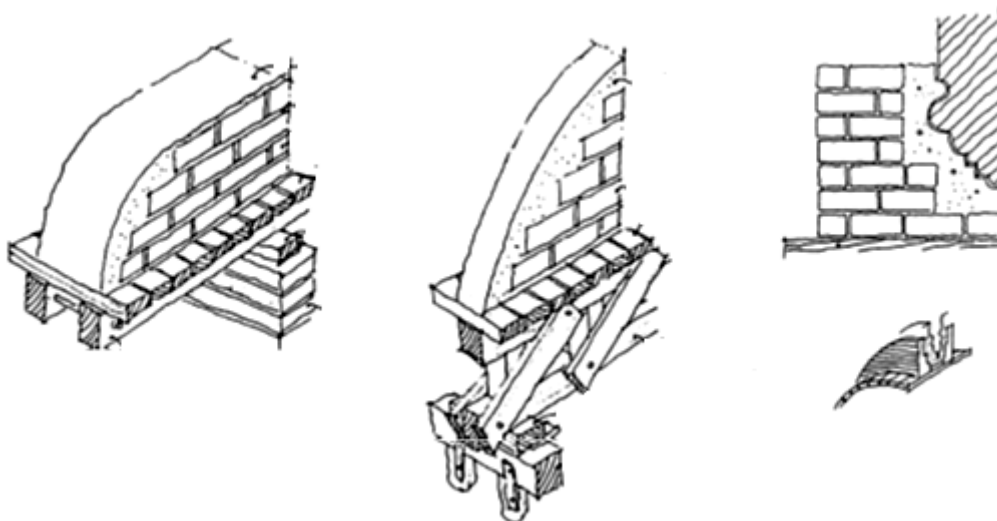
Apeo de arco mediante refuerzo con estructura de ladrillo
